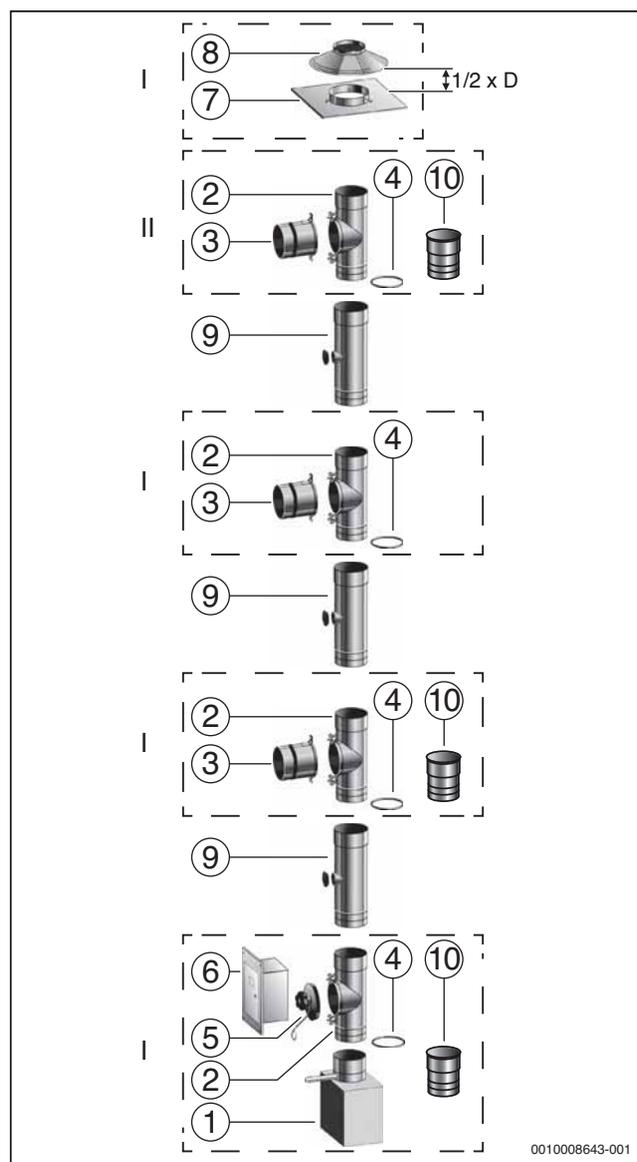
Bauteile des Bausatzes Mehrfachbelegung
